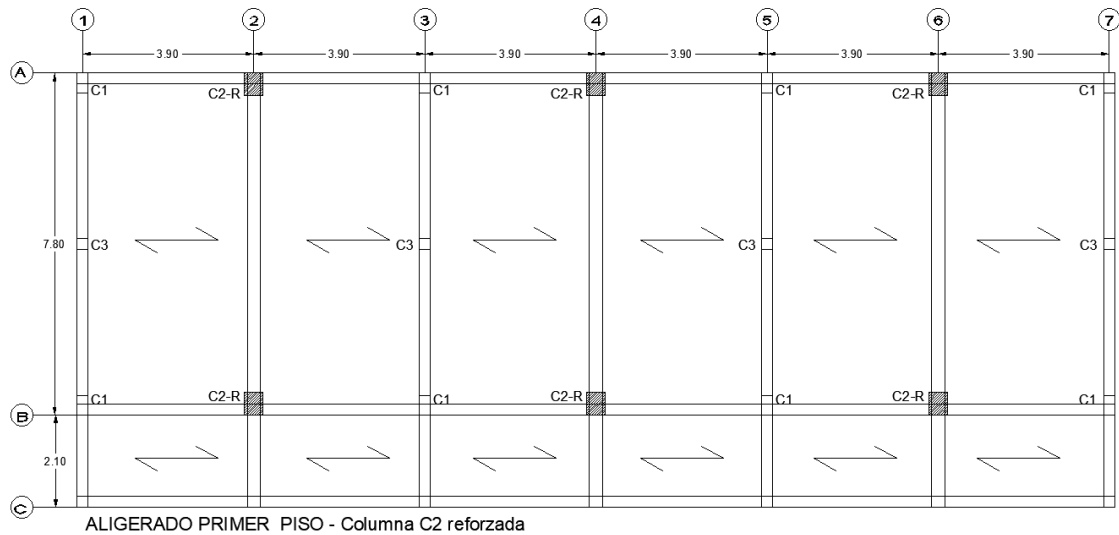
Columnas centrales reforzadas. Fuente: Propia.
